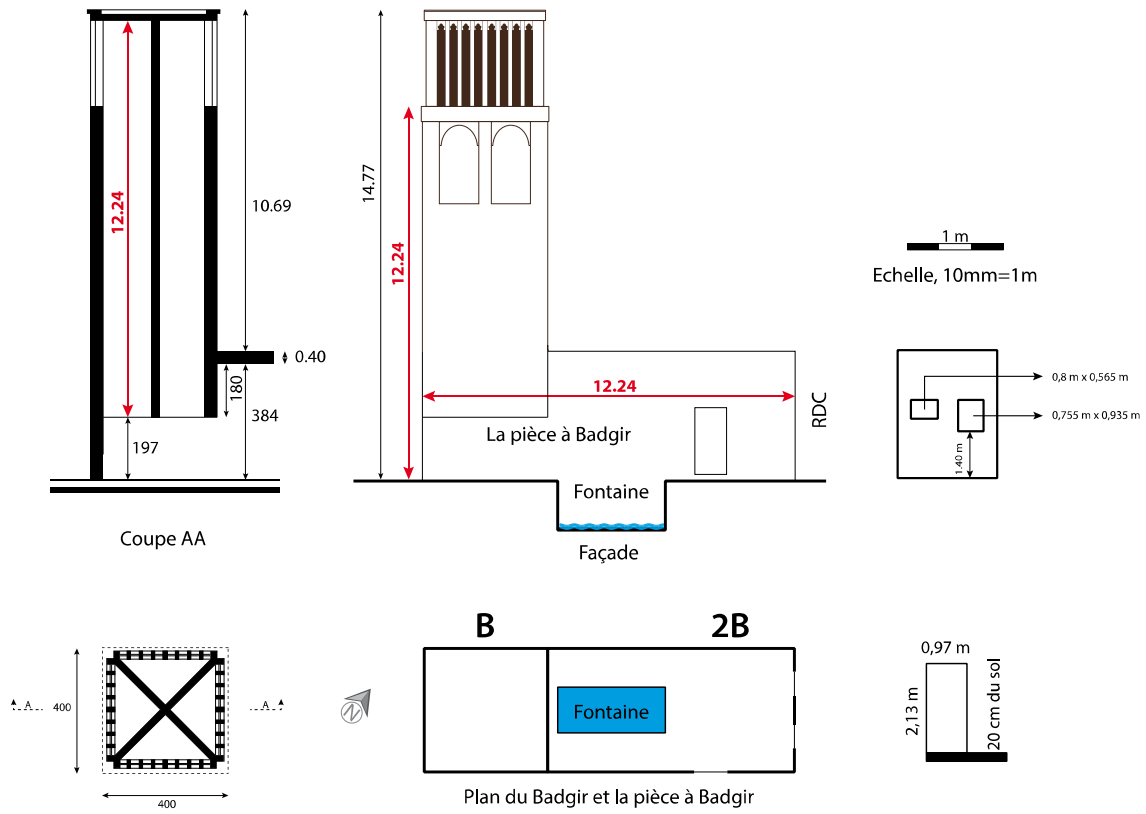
Plan, coupe et façade du Badgir de la maison de Nasuri à Siraf
